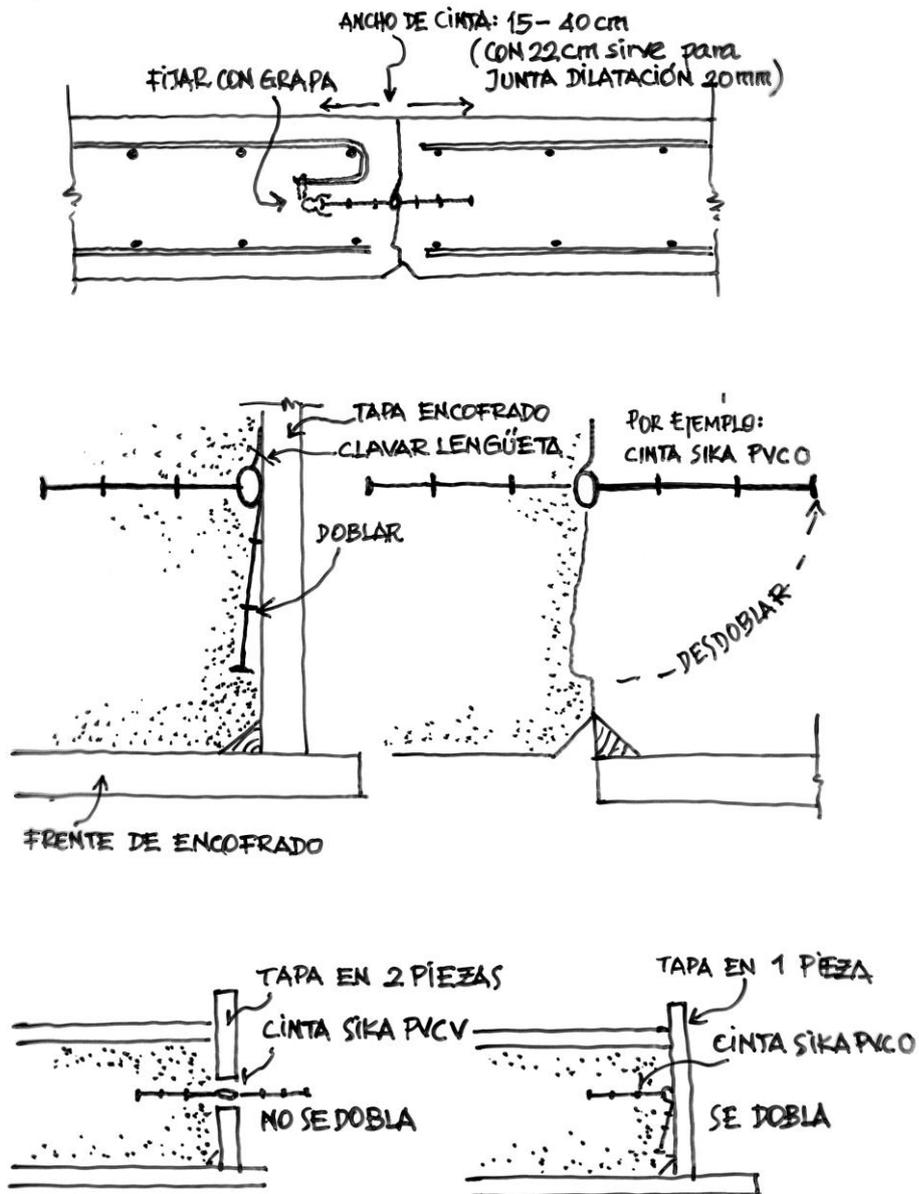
Esquema de junta de retracción de hormigonado de muro in situ con cinta de PVC central
